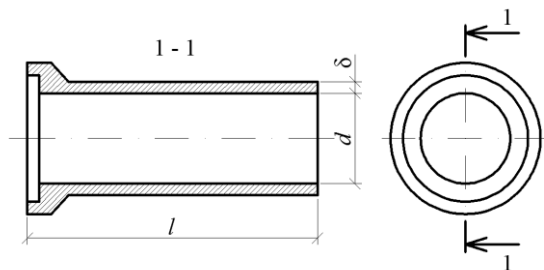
Труба железобетонная безнапорная раструбная типа Т
